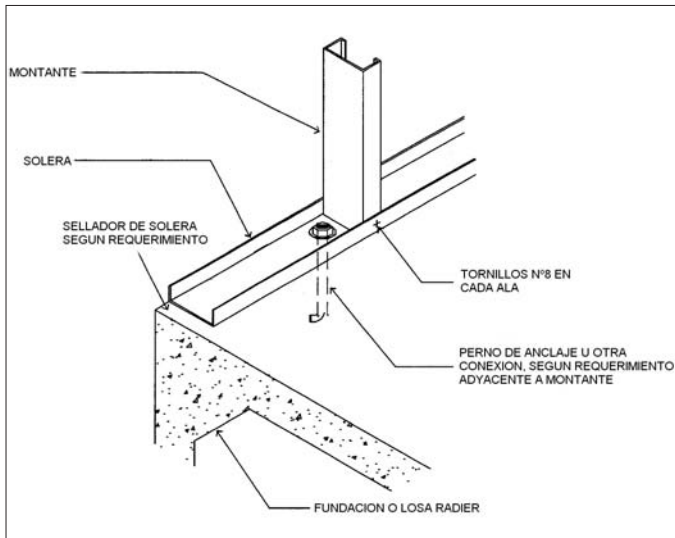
Alternativa de Conexión de Muro a Fundación
